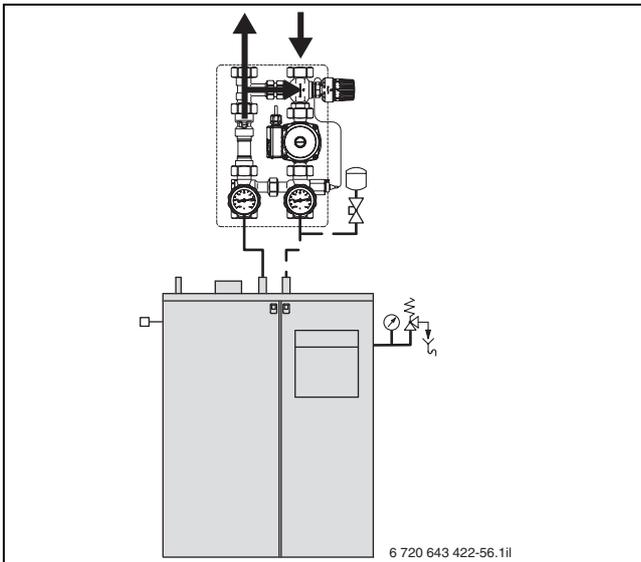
Einbau Schnellmontage-Set Oventrop Regumat RTA mit Logano SP161
